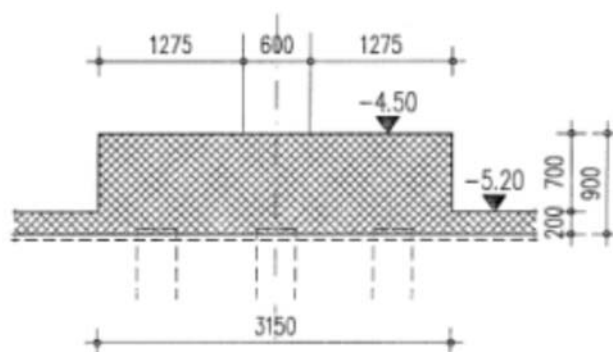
Типоразмеры ростверка при типовом конструктивном решении.
